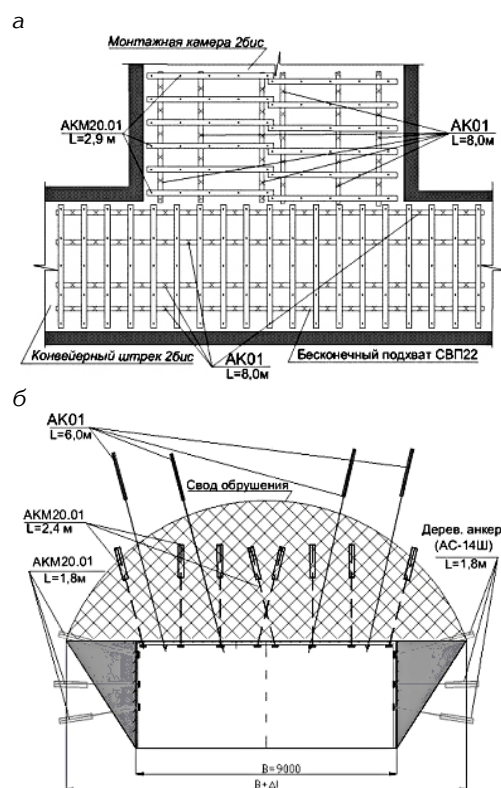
Двухуровневая схема крепления широких выработок на плане (а) и вертикальном разрезе (б). АК01 – канатный анкер; АКМ20.01 – анкер комбинированный металлический; АК – 14Ш – деревянный анкер; L – длина анкера, м; B – ширина камеры, м; Δl – величина возможного вывала пород, м
